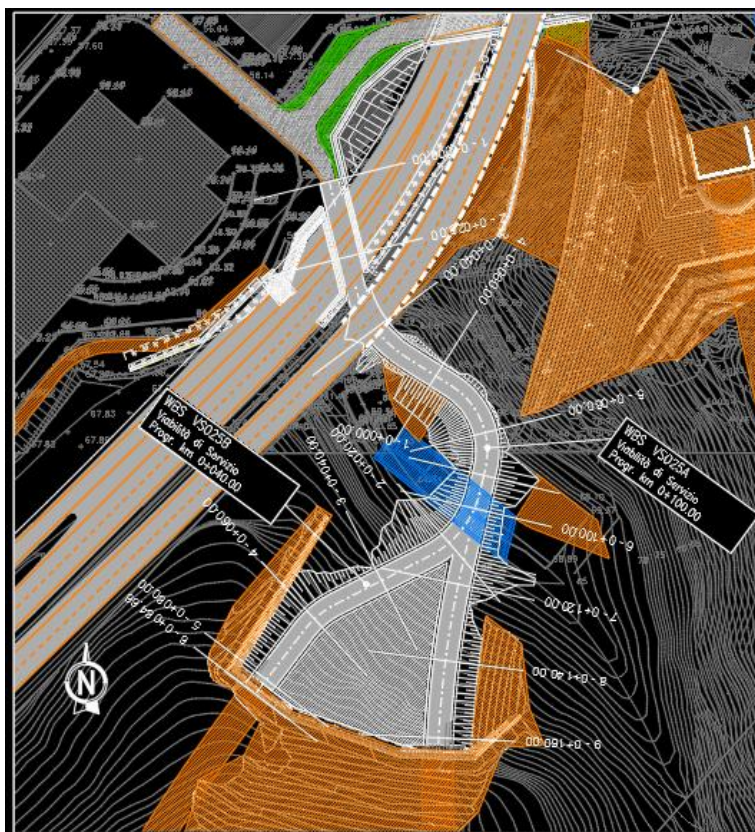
Stralcio planimetrico VS025A e VS025B
